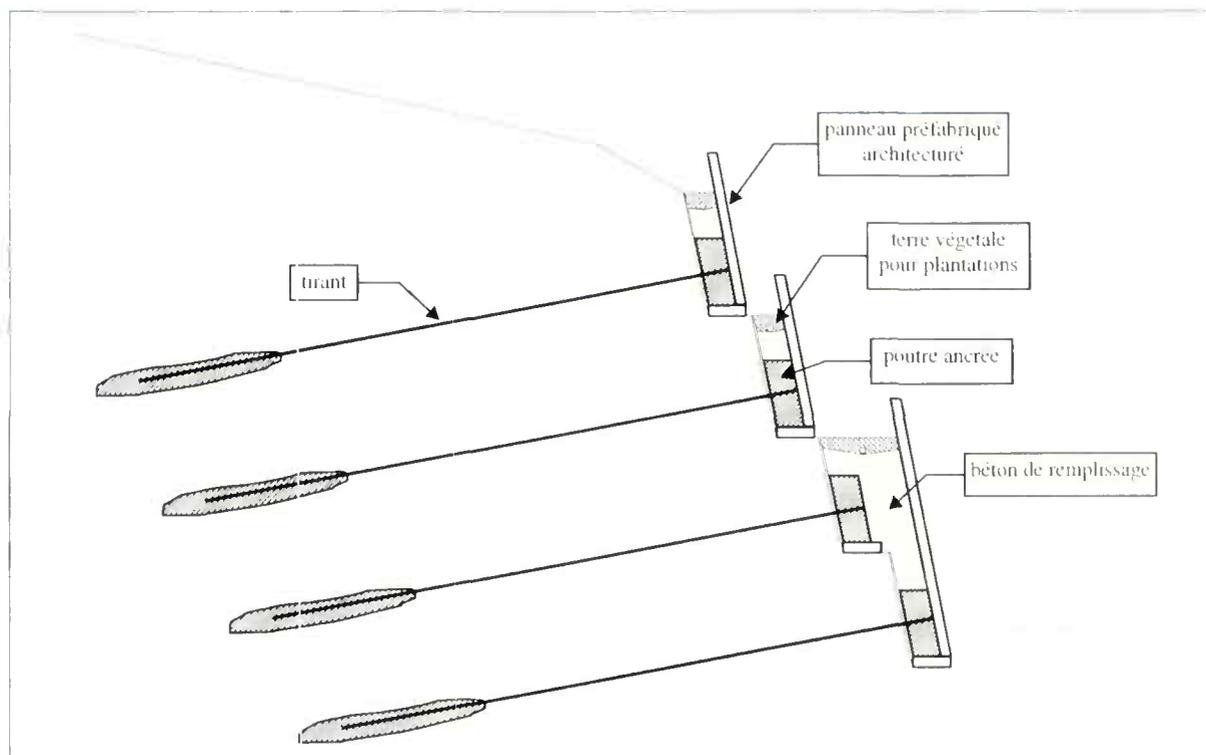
Coupe d'un ouvrage ancré avec risbermes
